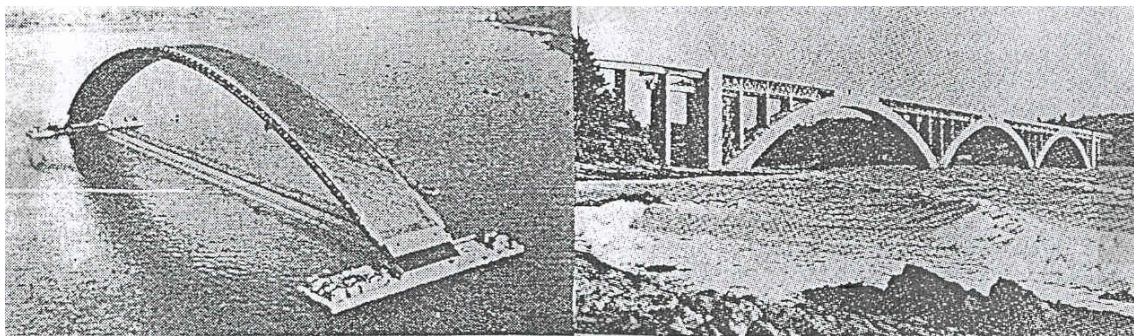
Primjer čelične skele izgrađene od standardnih dijelova
